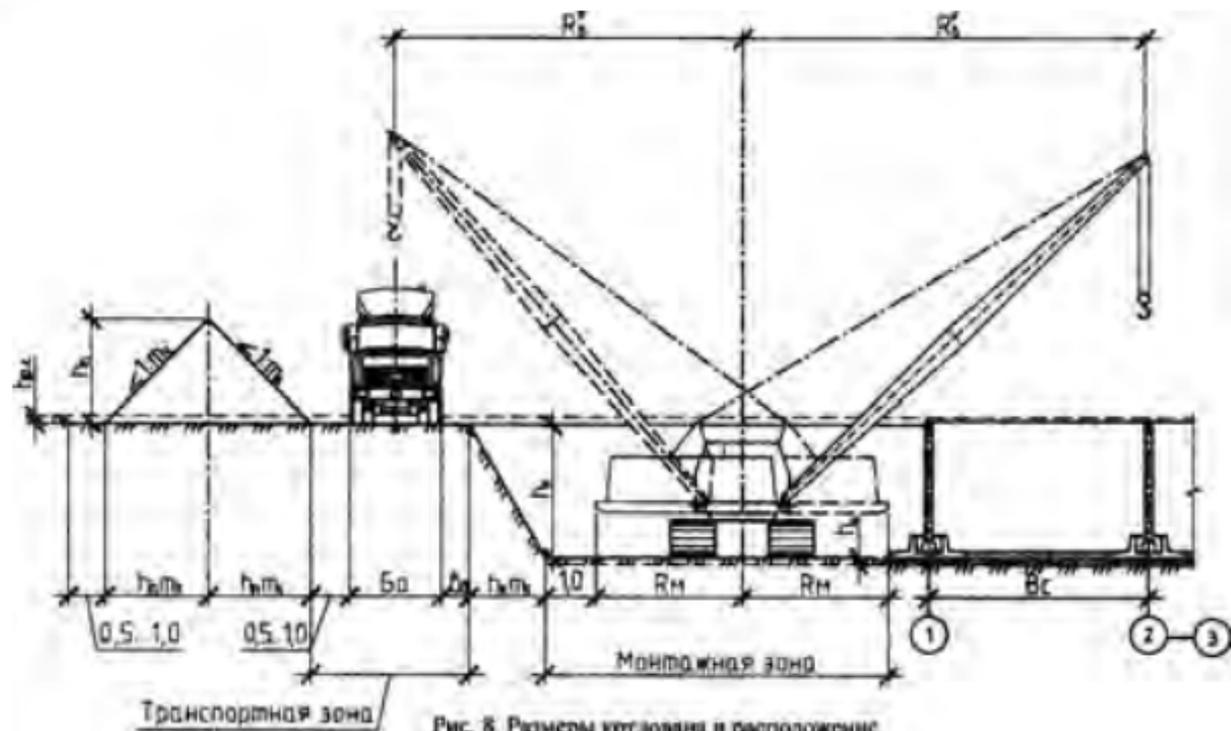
Размеры котлована и расположение кавальеров грунта для монтажной схемы II
